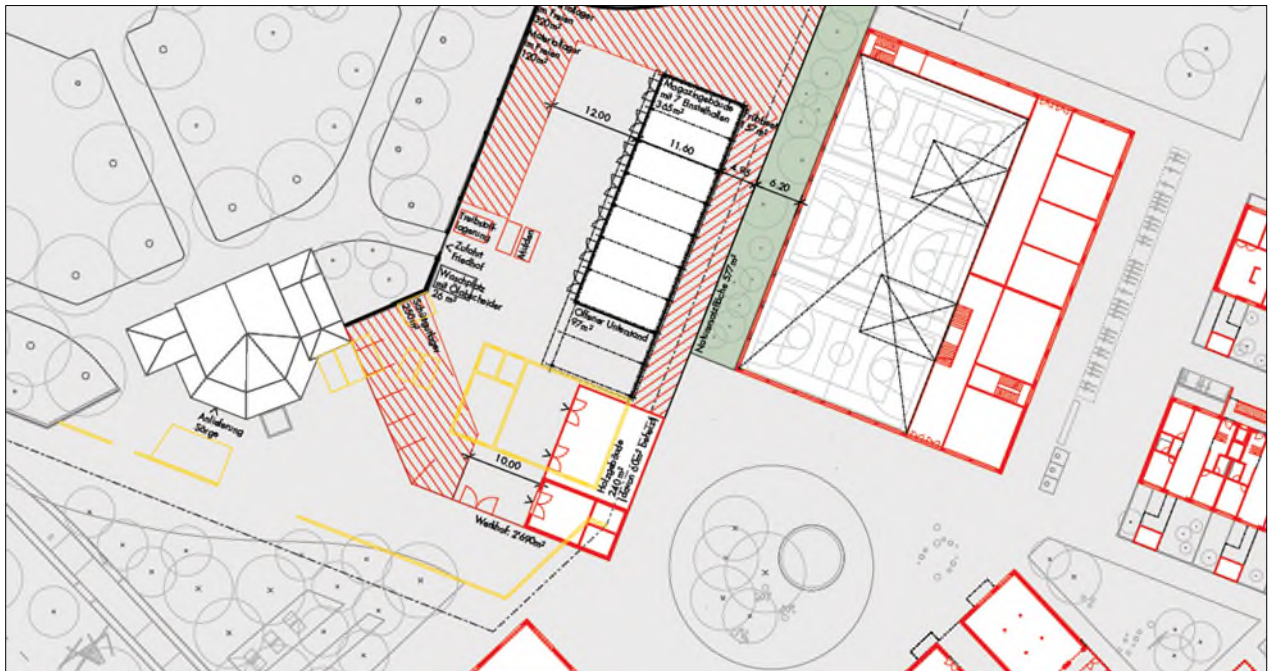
Anpassung Werkhof, rot; neu, gelb; Abbruch © camponovo baumgartner architekten gmbh
